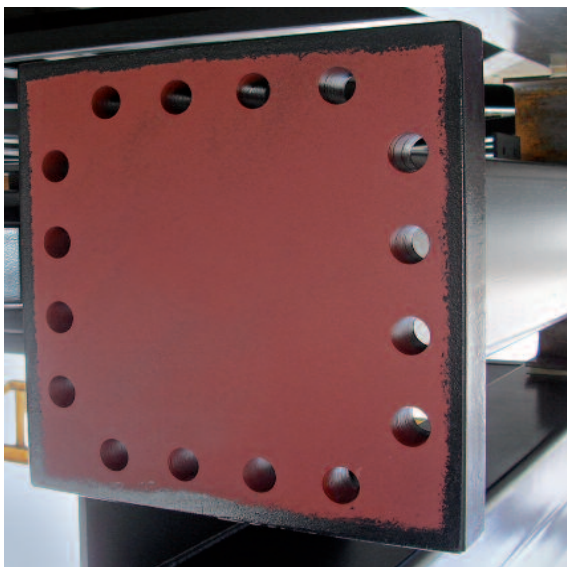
Typisch für den Stahlbau: eine zu verschraubende Fußplatte
